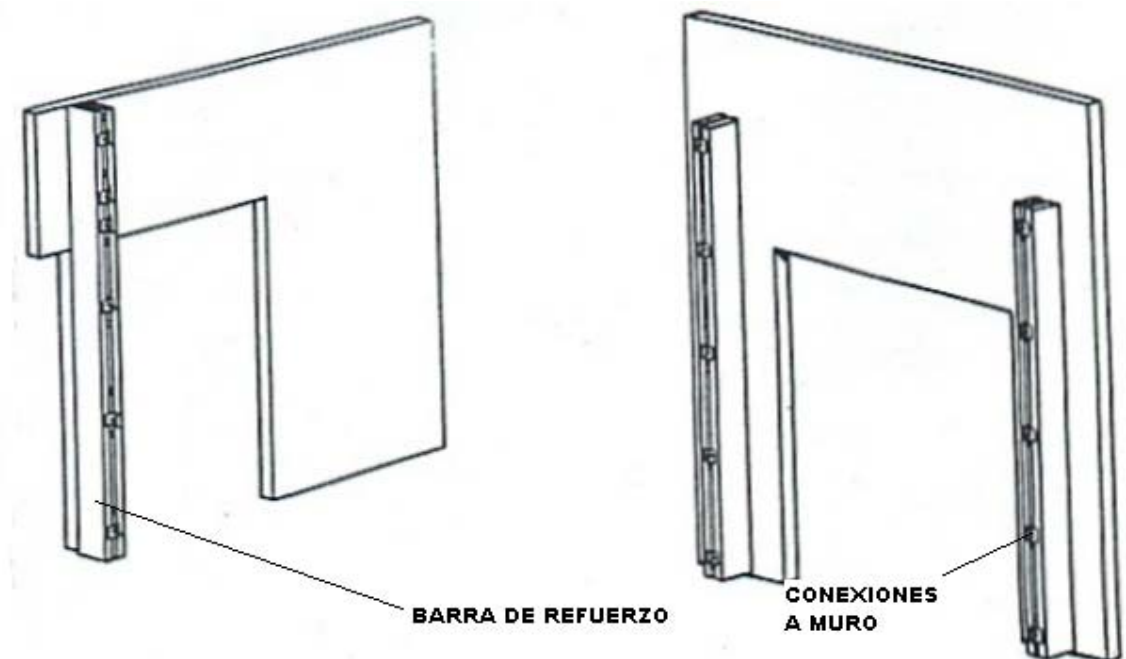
Colocación de barra de refuerzo en franjas esbeltas.
